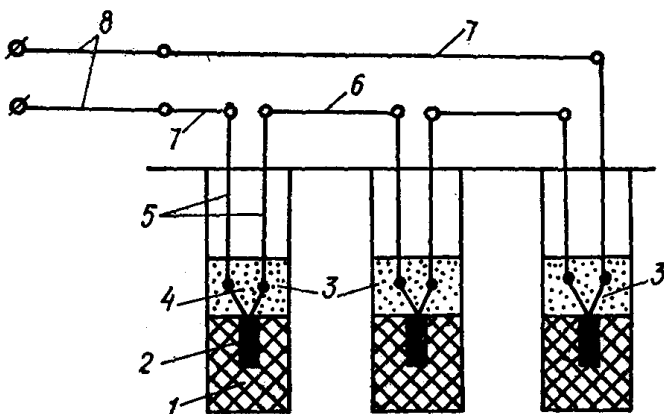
Схема последовательного соединения проводов электровзрывной сети:
